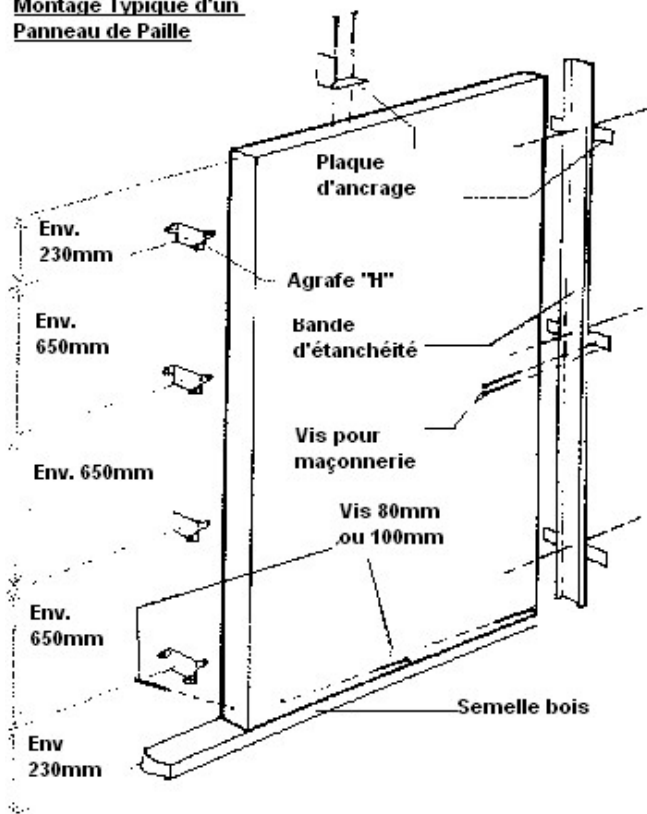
Montage du premier panneau avec plaque d'ancrage
